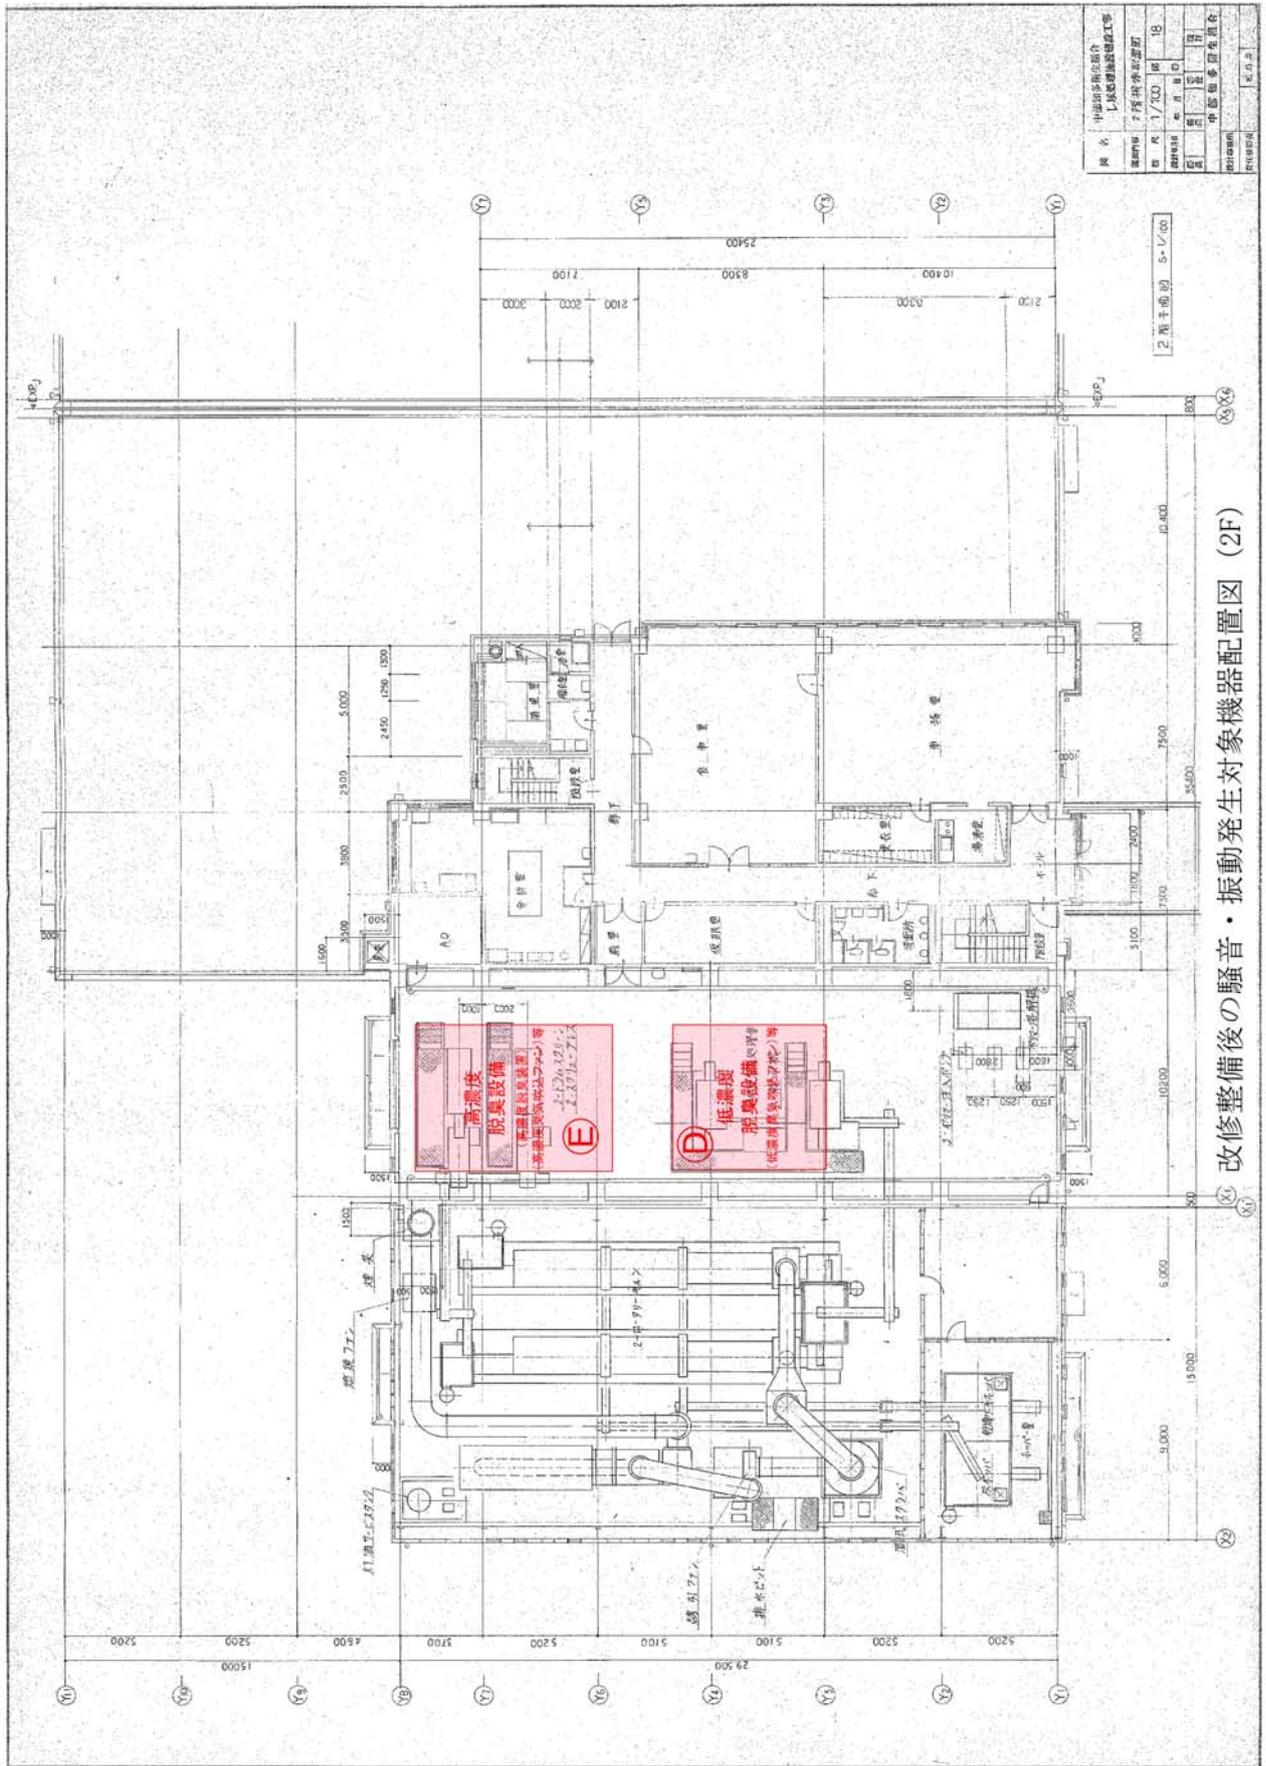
(3) 改修整備後機器配置図 (3/3)
